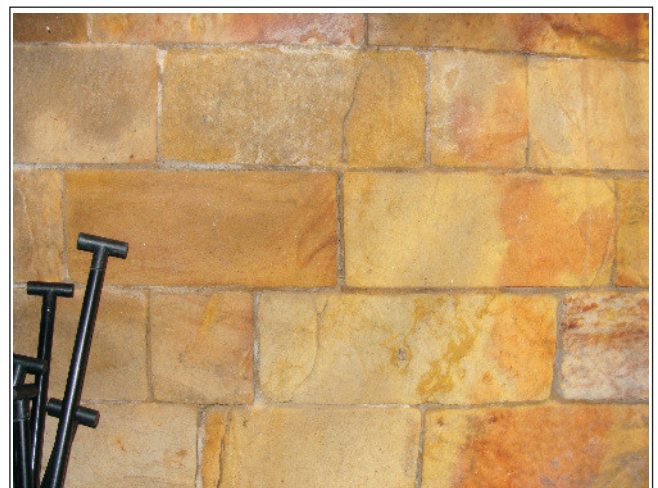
Ansicht Mauerwerk mit Riss durch Steine und
